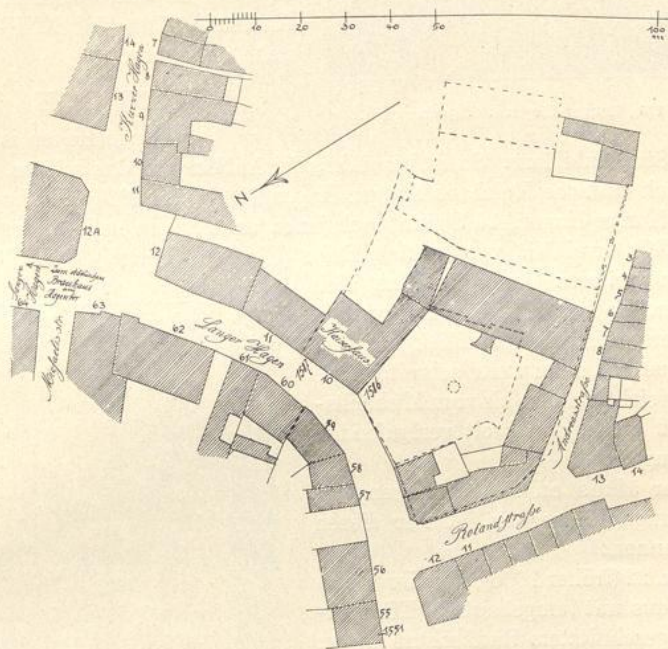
Ecke Langer Hagen—Kurzer Hagen. Lageplan.
